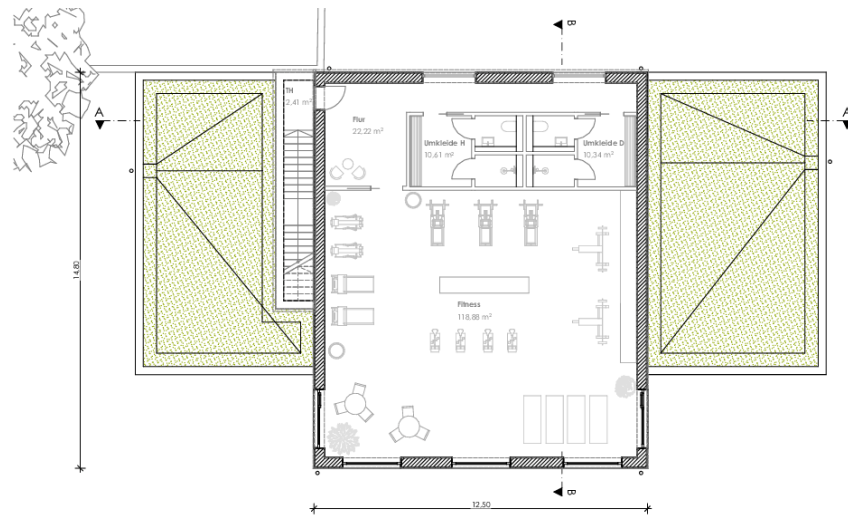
Grundriss 1.OG, Quelle: Anderer Architekten, vom 09.01.2024
